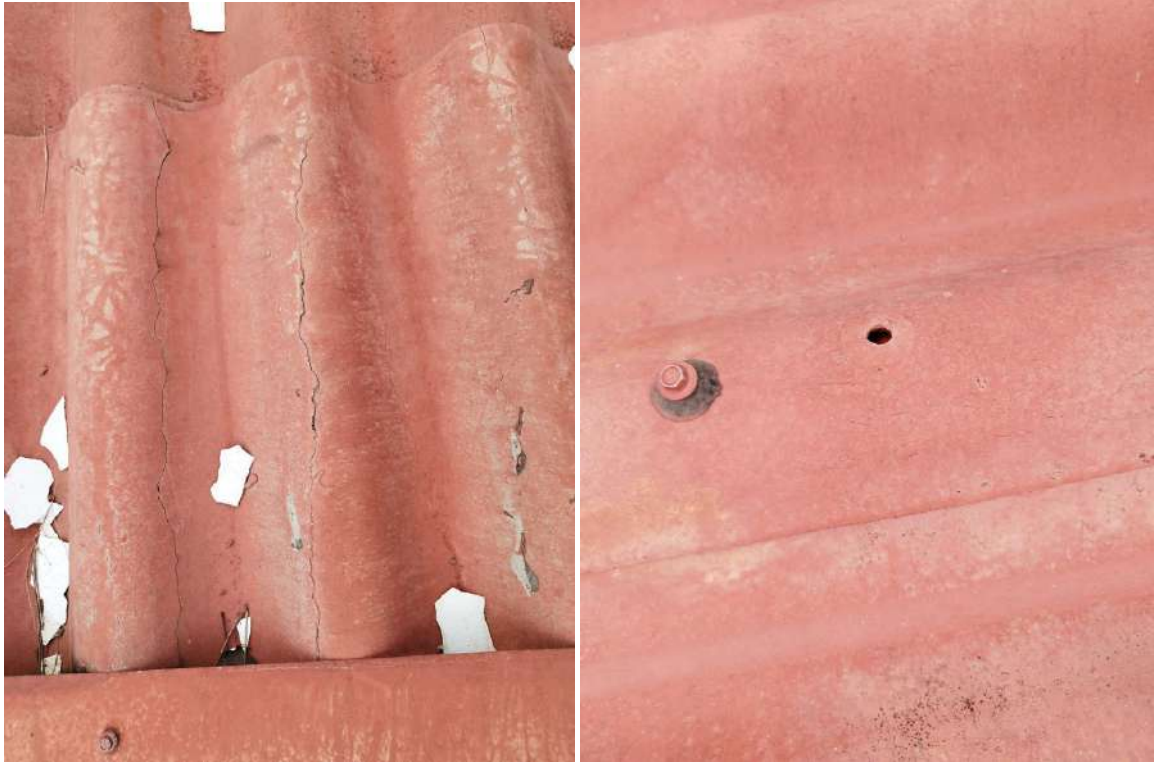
e 19 – Destaque para o telhado do pavimento superior com as telhas quebradas, furadas e trincadas.
